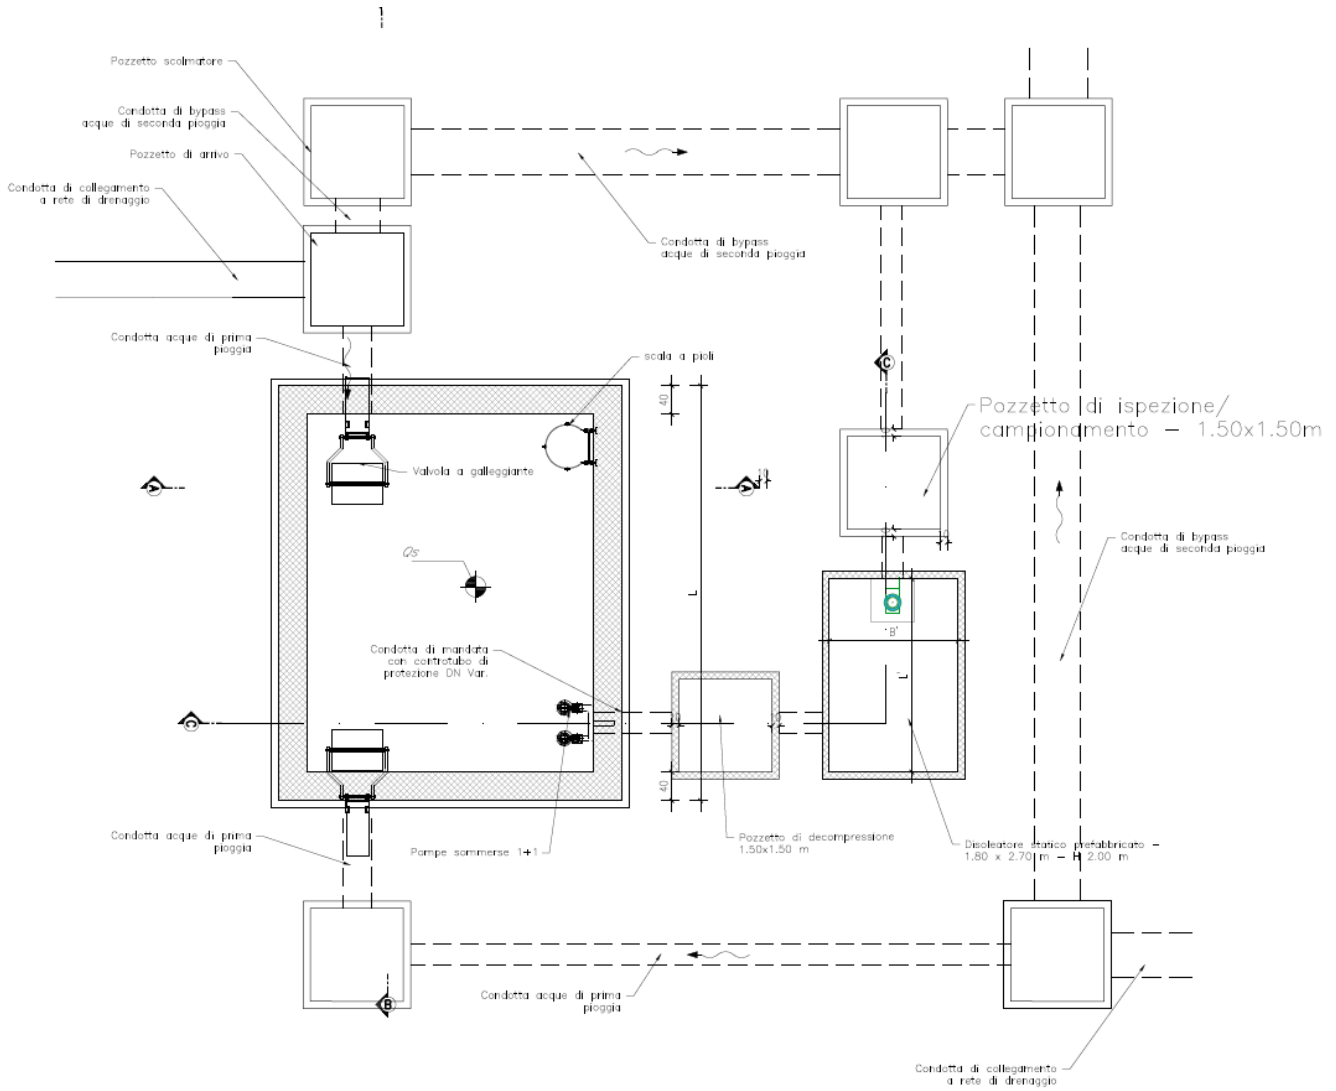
Tipologico IPP "completo" – Impianto di sollevamento e vasca di prima pioggia – stralcio planimetrico
